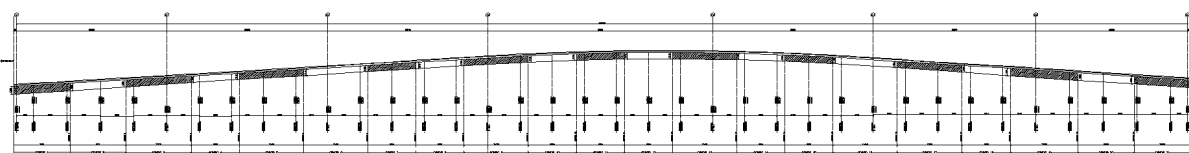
Sovrappasso di ingresso – sezione longitudinale trave interno curva
